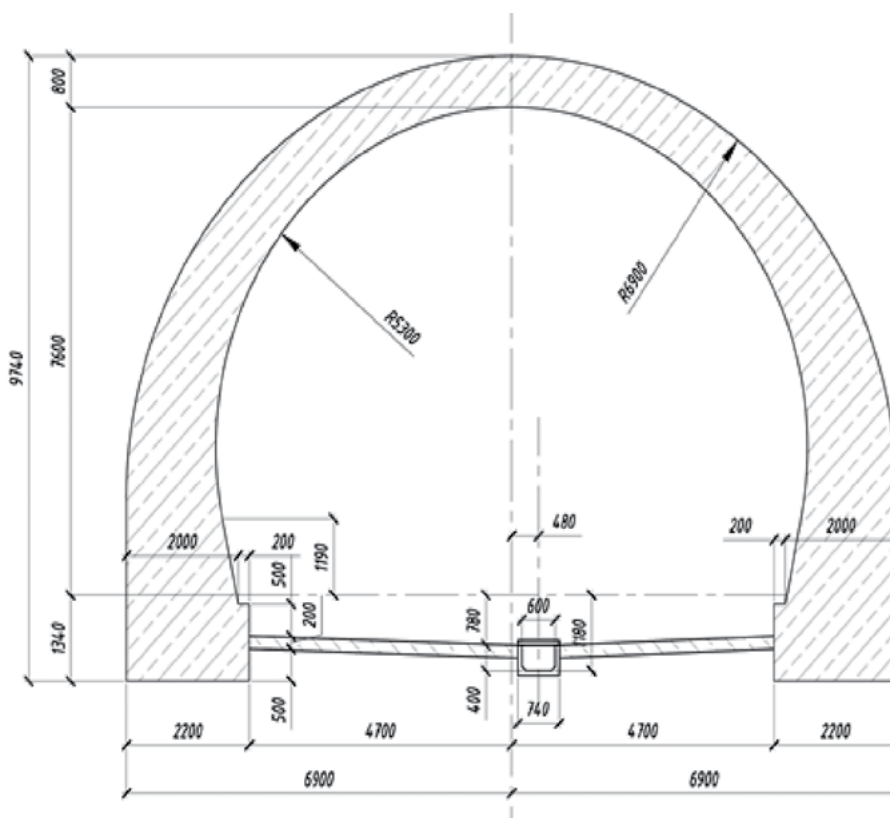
Чертеж типовой конструкции обделки тоннеля Сухарный
